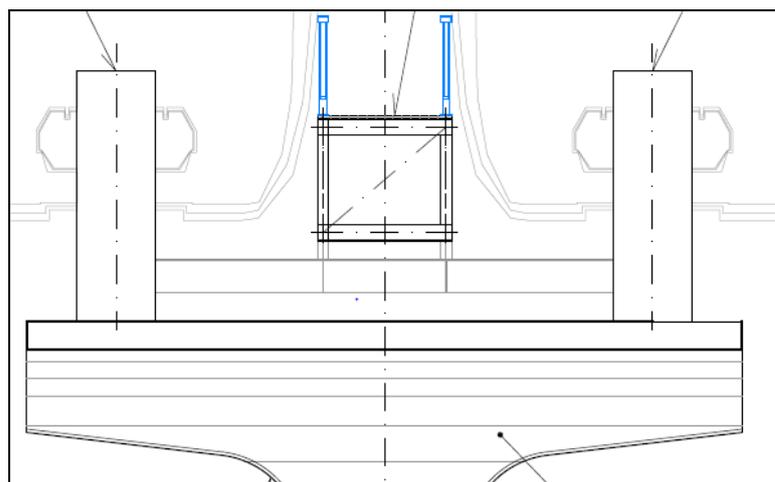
Detalhe da viga apoiada na travessa.
